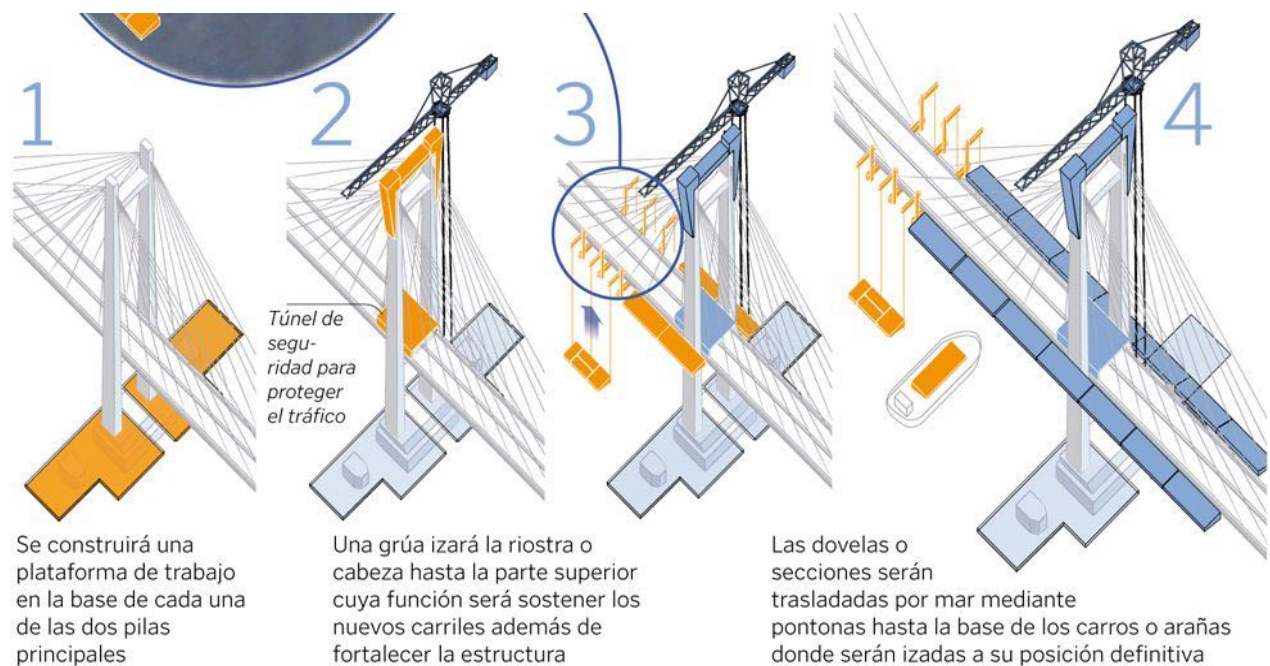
Esquema del proceso constructivo por fases. [17] (Ayerre)
